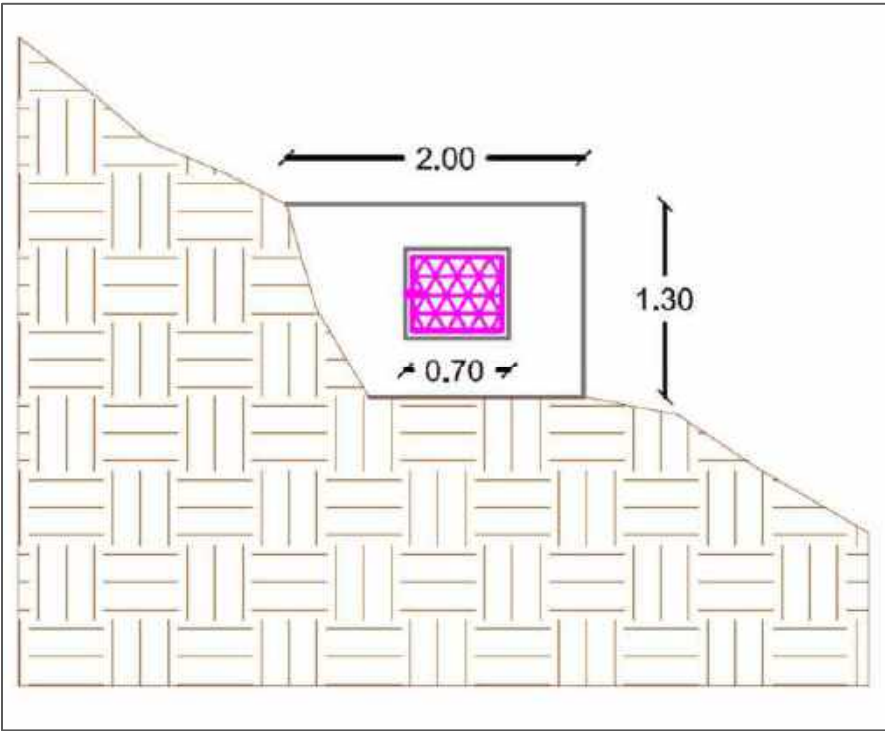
Prospetto frontale Sorgente 1 Le Pierine
